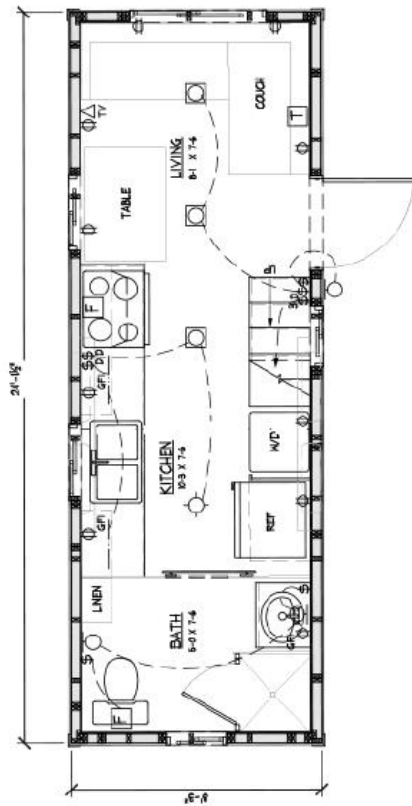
Planta arquitectónica tiny house de 18 m² y 21 m². Fuente: Tiny house designing, building and living, 2017
